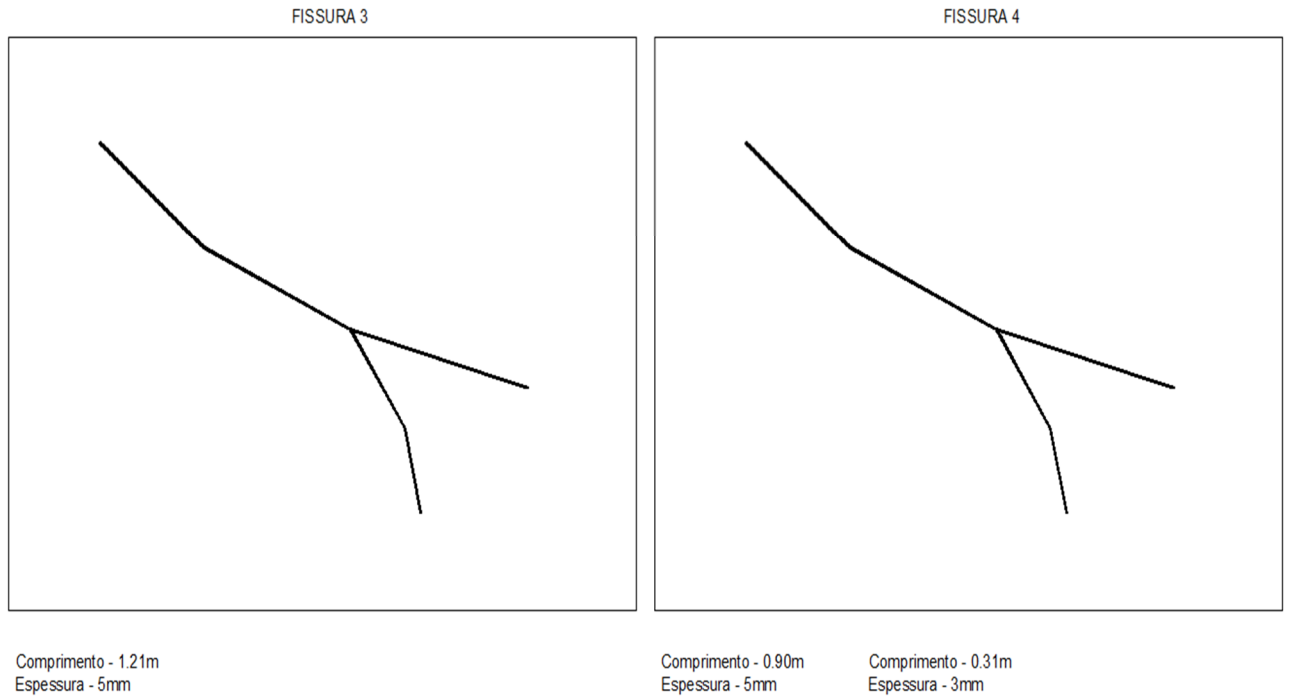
Fissuras 3 e 4 criadas em AutoCAD
